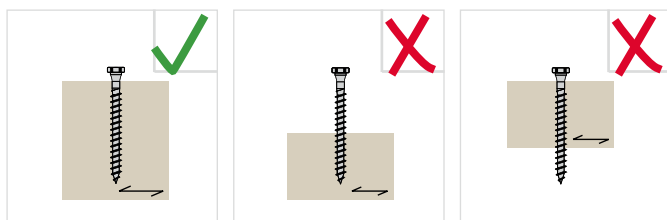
Auf korrekte Einschraubposition achten: das Gewinde muss zur Gänze im Bauteil sein
